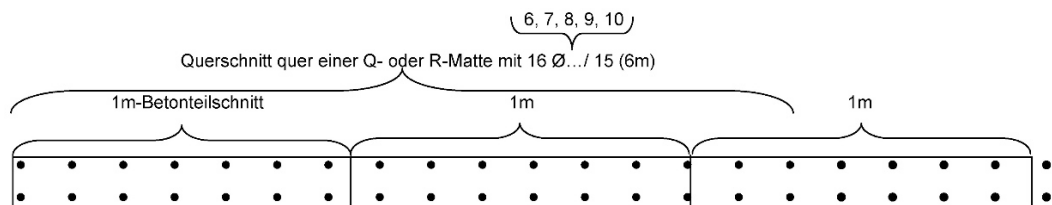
Betonteilmeterschnitt, dreimal maßstabsgerecht hintereinander gelegt, mit einer Matte im Querschnitt
